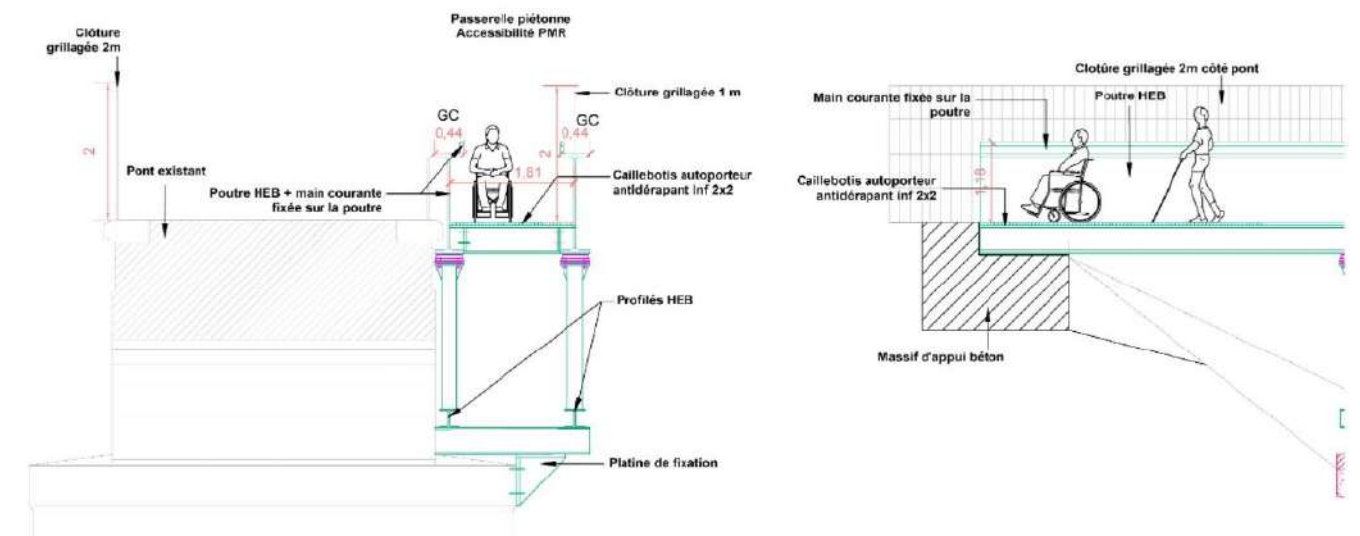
Coupe détaillée de la passerelle piétonne projetée
